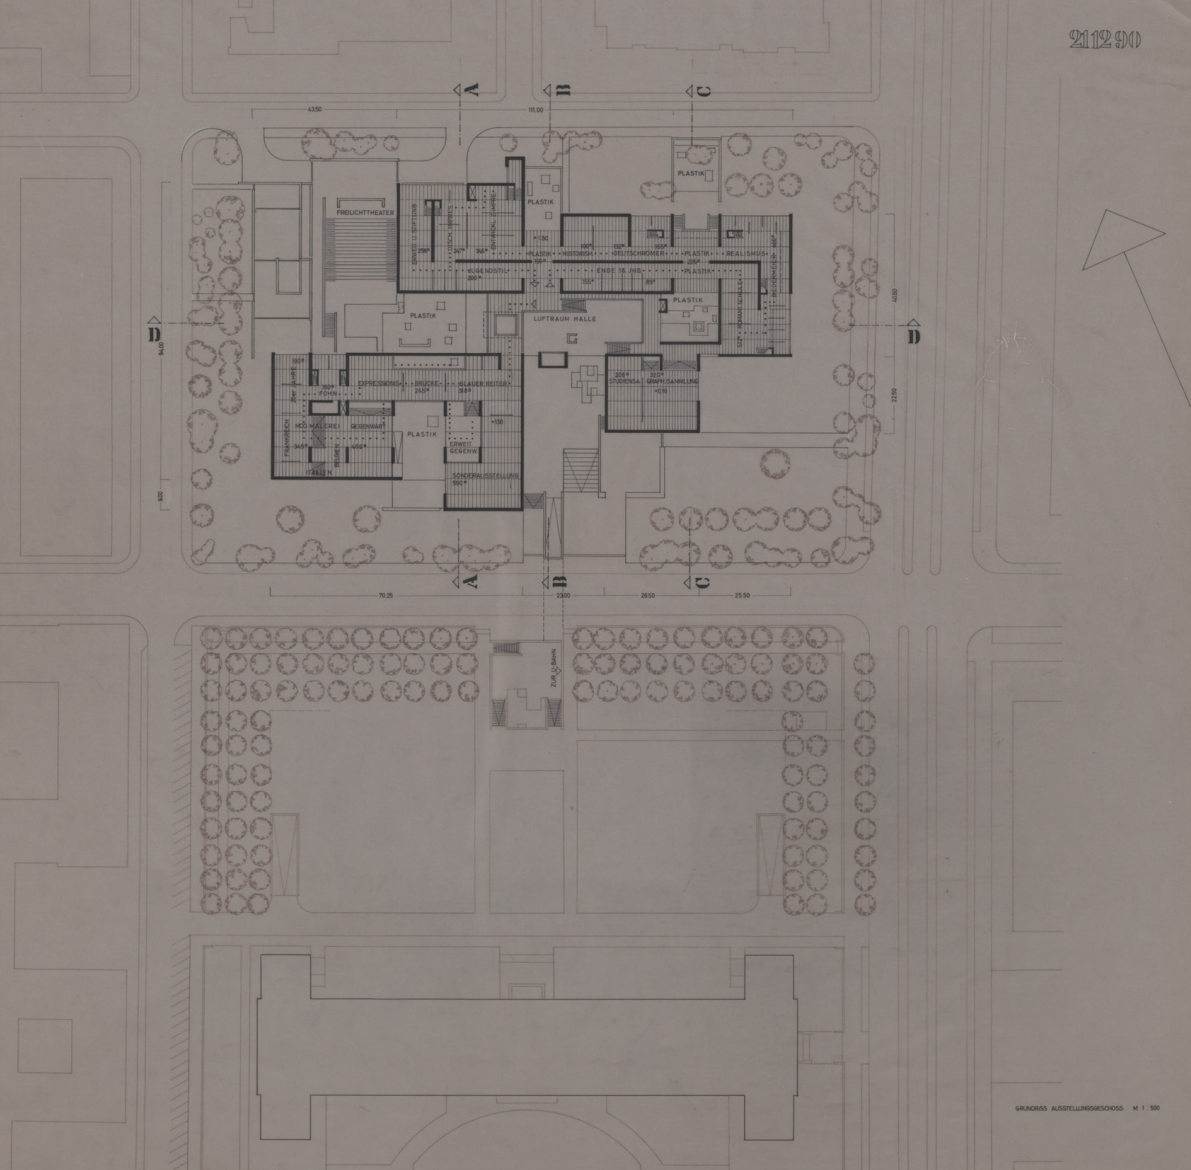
Architekturmuseum der Technische Universität (1975-81): Neue Pinakothek - Lageplan; Ausstellungsgeschoss (Grundriss).
